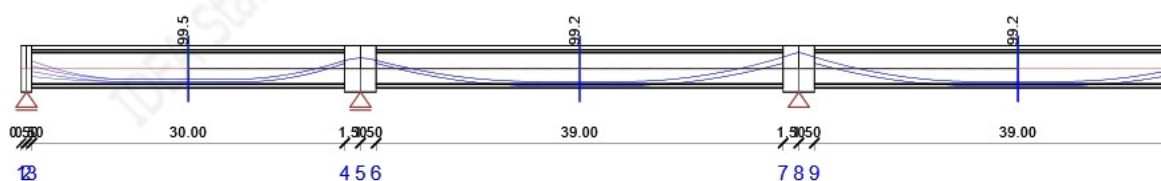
Posuzované průřezy prefabrikované konstrukce - nad podporou
